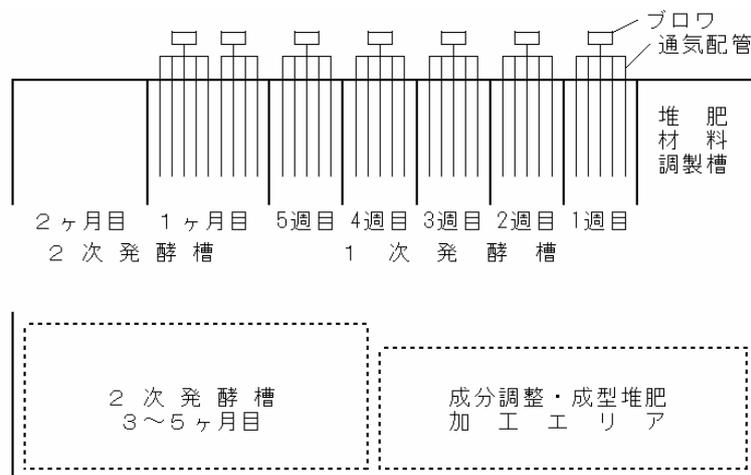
九州沖縄農研センターの通気式堆肥舎の平面図
